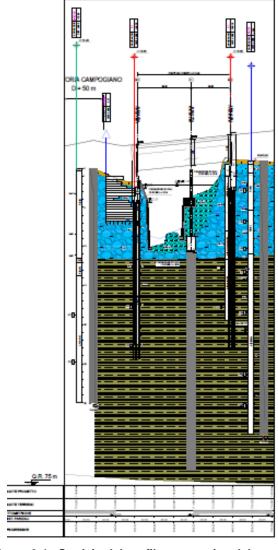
Stralcio del profilo geotecnico del ponte
